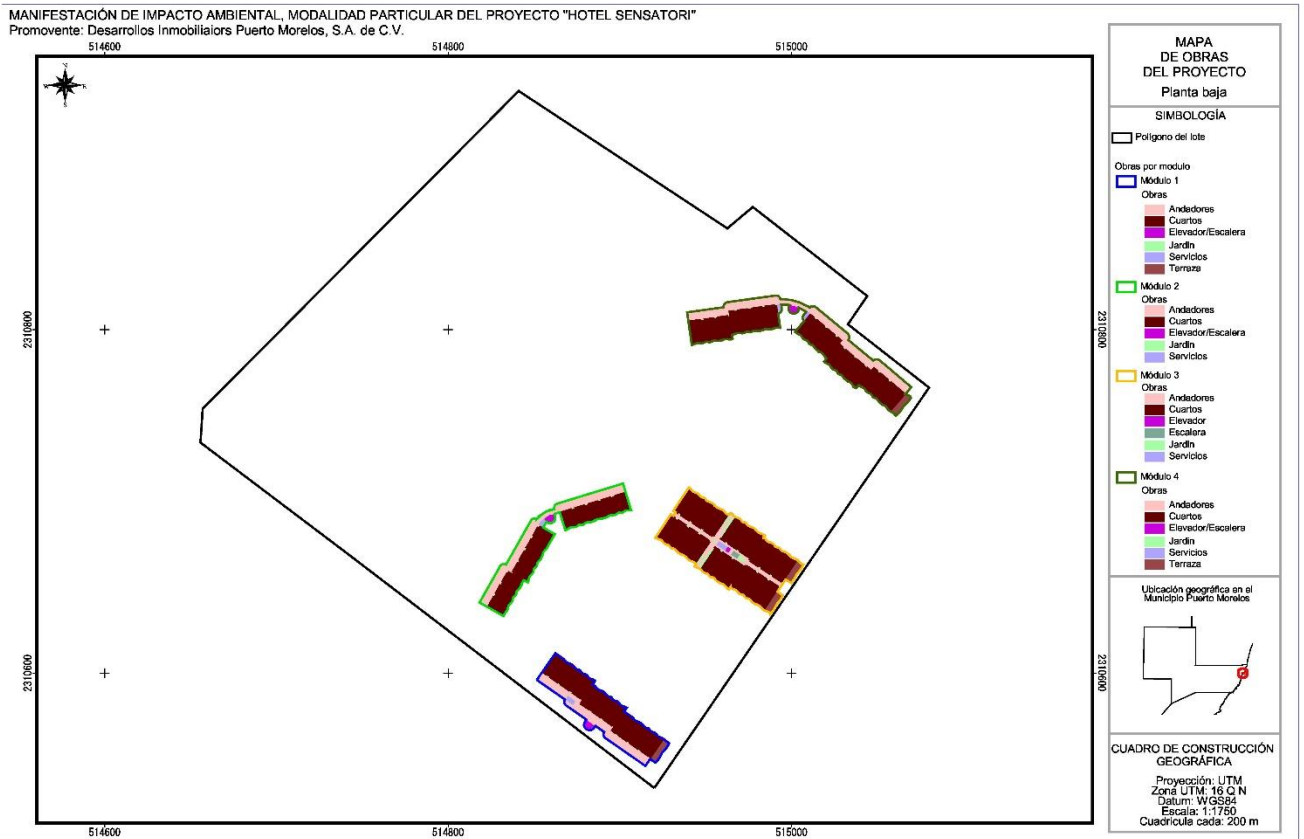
Plano de conjunto ampliación del proyecto "Hotel Sensatori" Nivel planta baja
